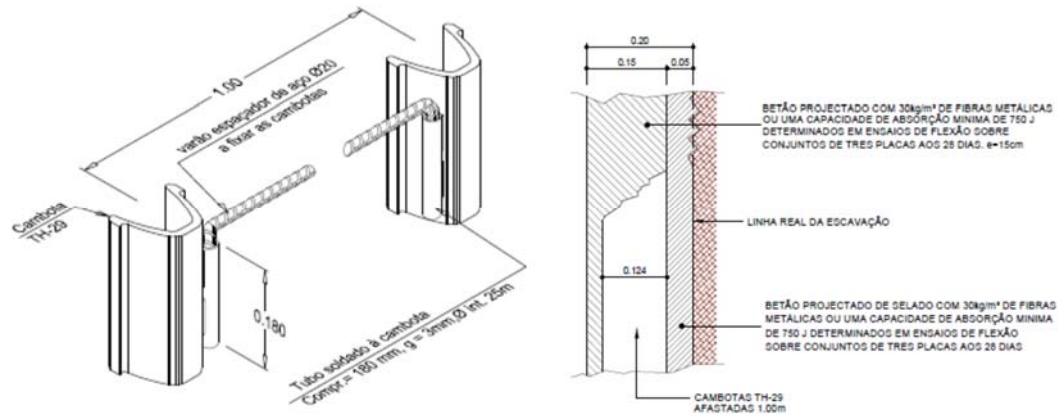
Detalhe de uma cambota em perfis TH-29
